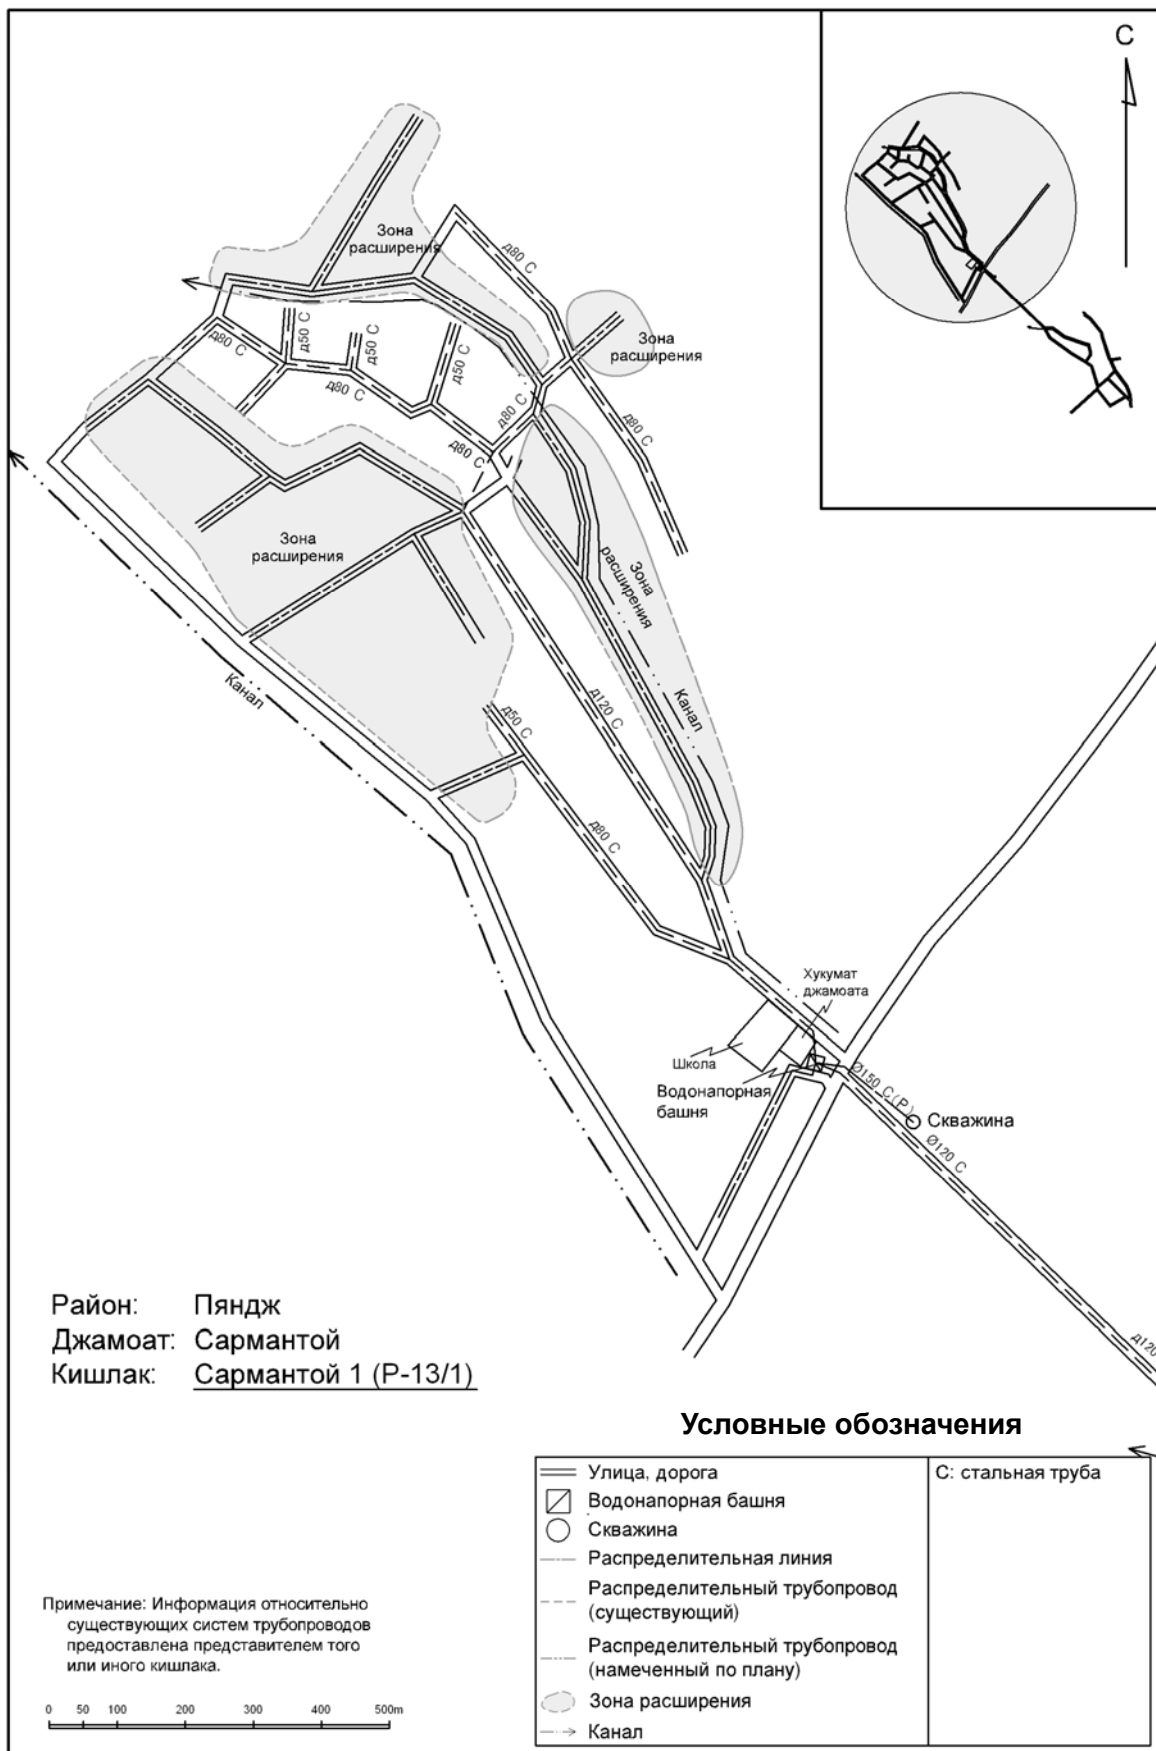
(2/3) Р-13 Сармантой: Сармантой-1
